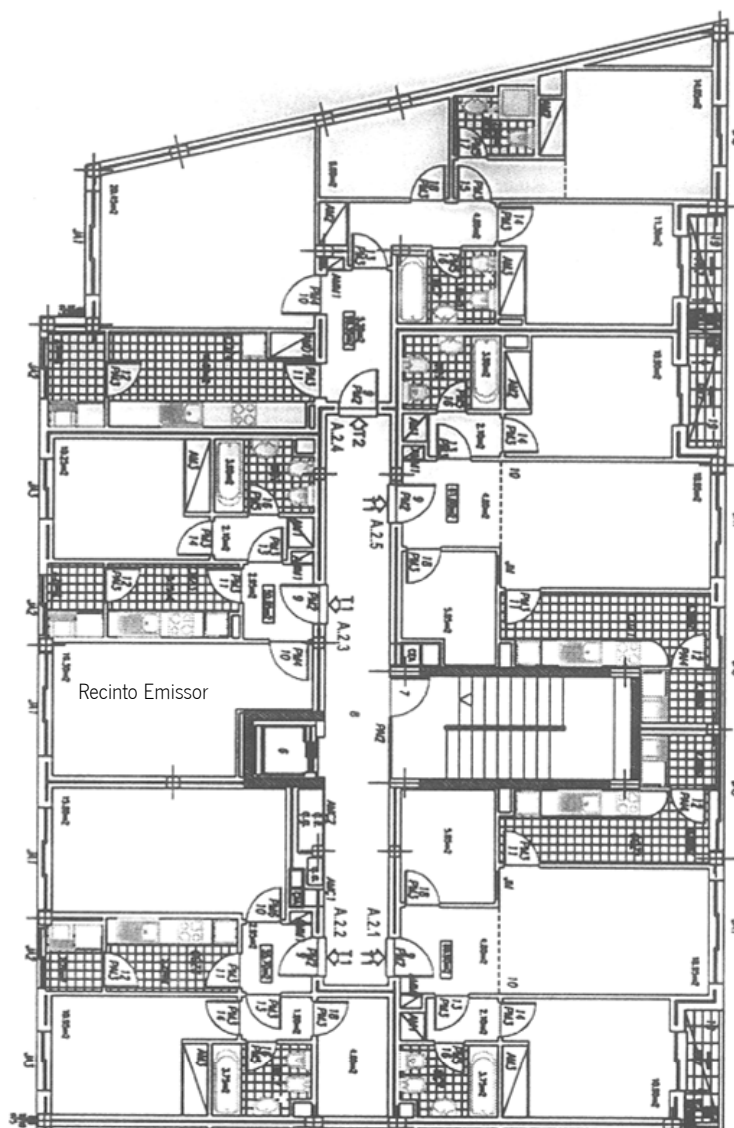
Planta do recinto receptor do ensaio de avaliação do isolamento da parede exterior 3, ParE3
